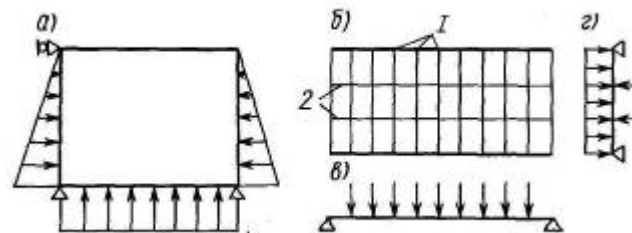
Рама и перекрытие: а - схема нагрузки на раму; б - схема перекрытия; в, г - схема нагрузок на балки главного направления и перекрестные связи. 1 - балки главного направления; 2 - перекрестные связи
